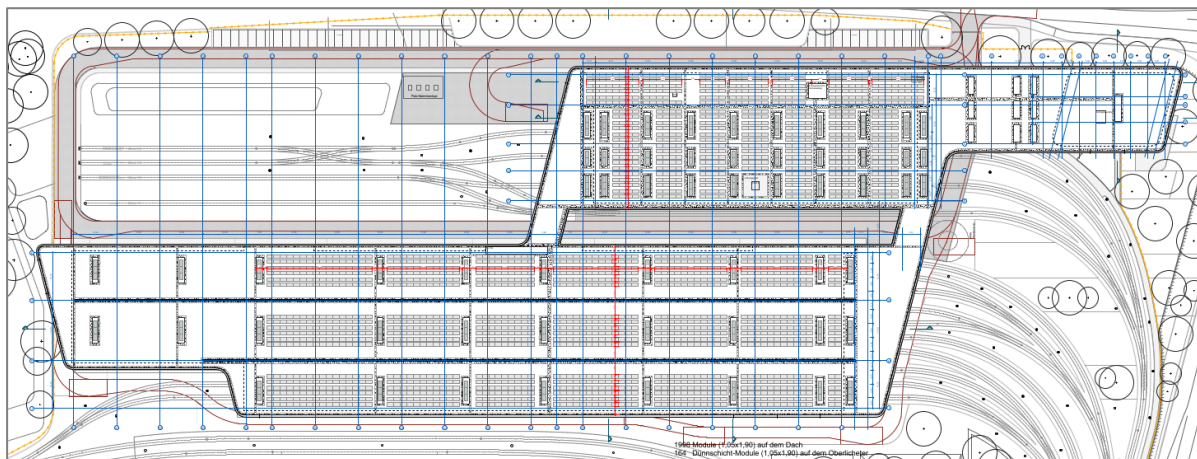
Dachaufsicht Dienst-Sozialgebäude, Werkstattgebäude, Abstellhalle
